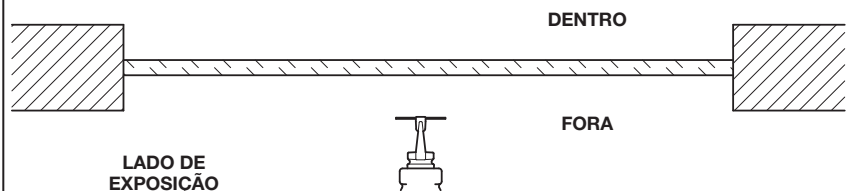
A-3 -- SEPARAÇÃO DE INCÊNDIO EXTERNA - SPRINKLERS NO EXTERIOR
